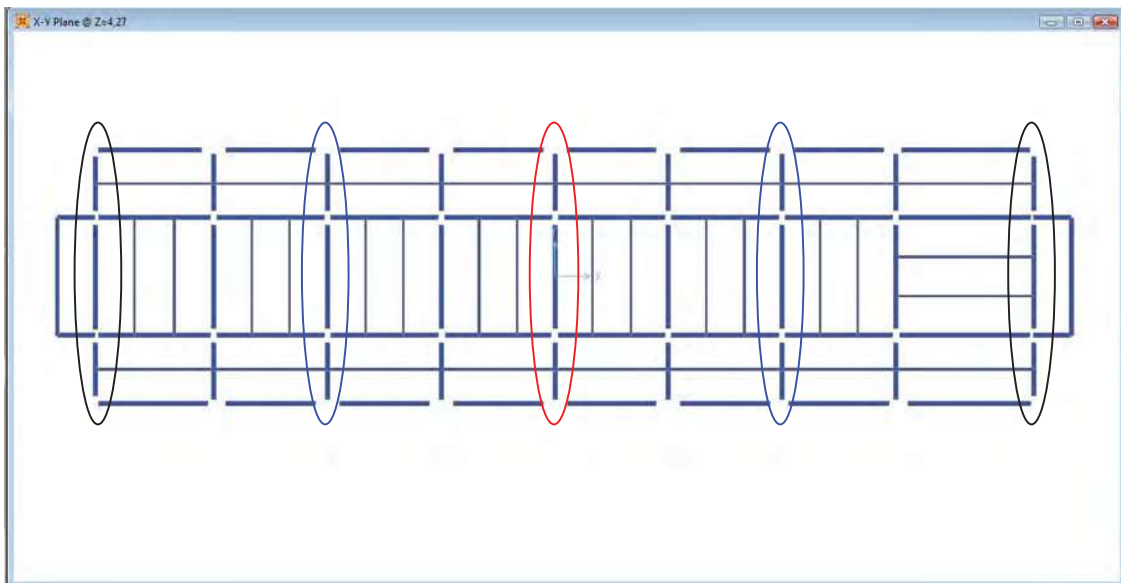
Vista en planta primer nivel de la estructura con posición de marcos tipos con amortiguadores.
